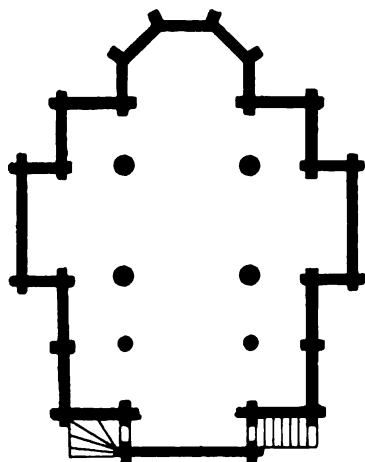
Löwen. Grundriß für eine Kollegskirche.
